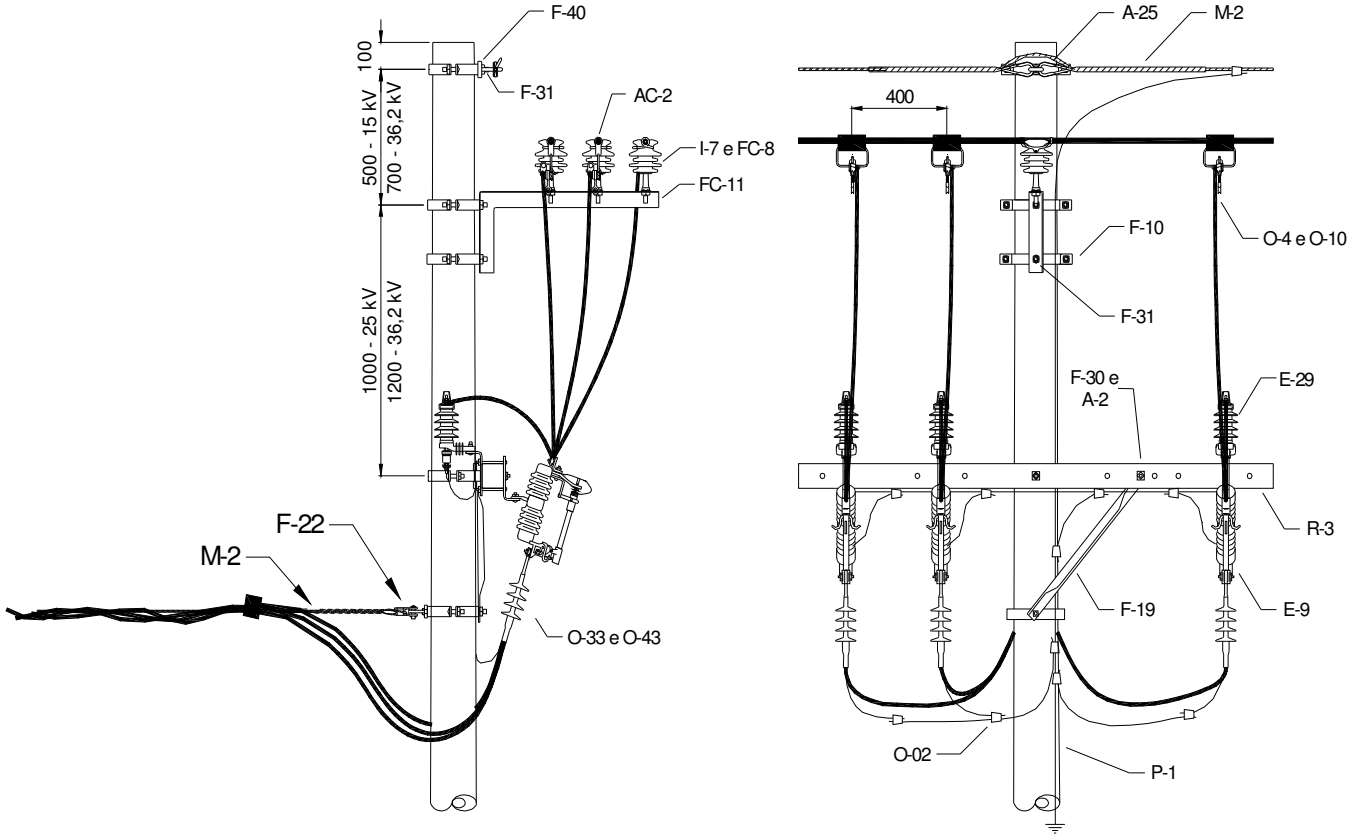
Estrutura CE2 SH-CE3 CF – Poste de Concreto de seção DT
